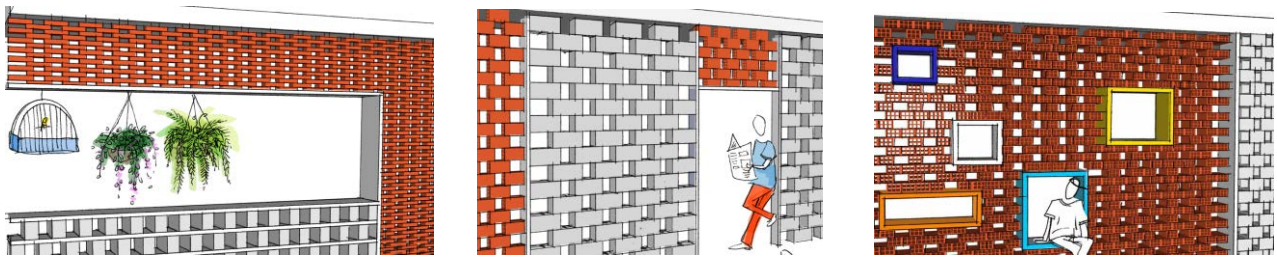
Ilustrações de aplicações possíveis do elemento vazado na fachada externa, fornecendo sombra e ventilação permanente. Fonte: PIZARRO, 2014.
